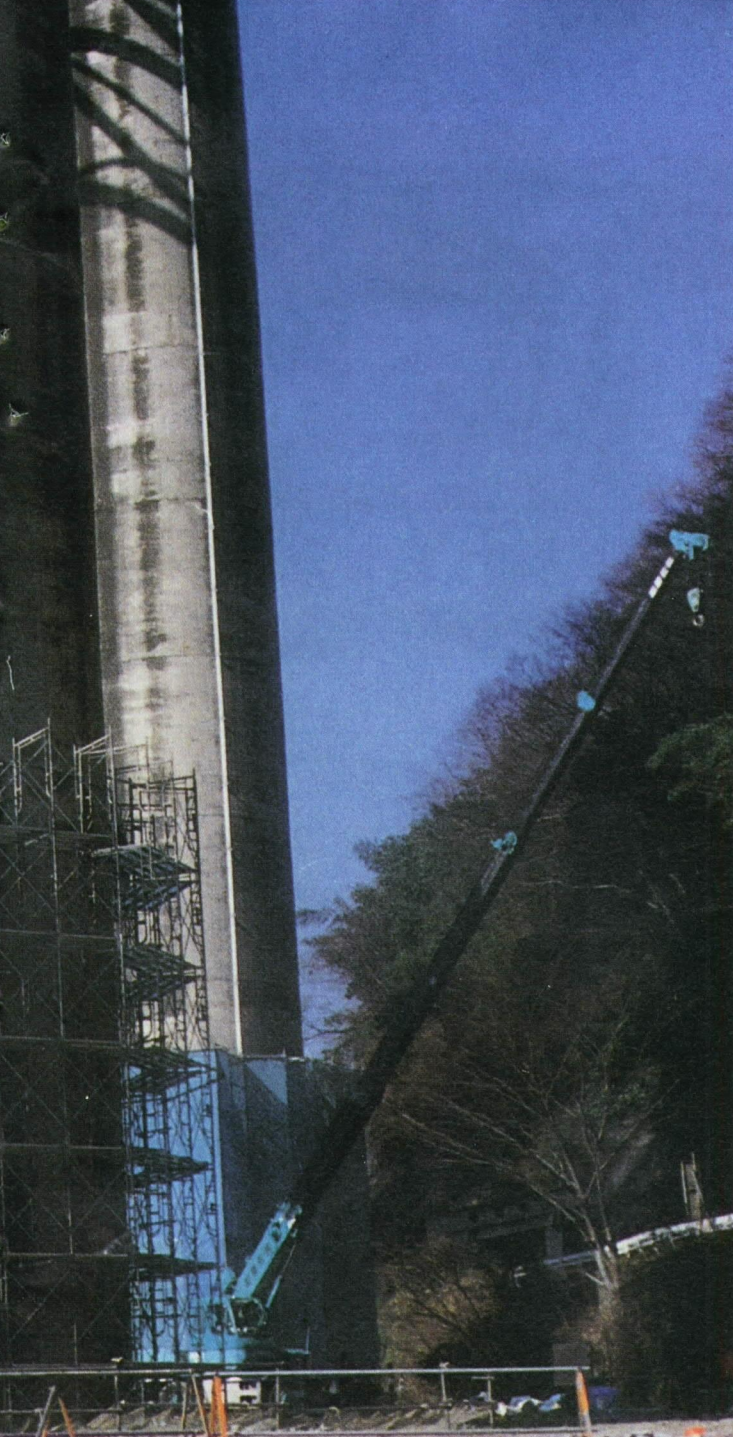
東名高速道路川崎高架橋（コンクリート巻立てによる補強）
